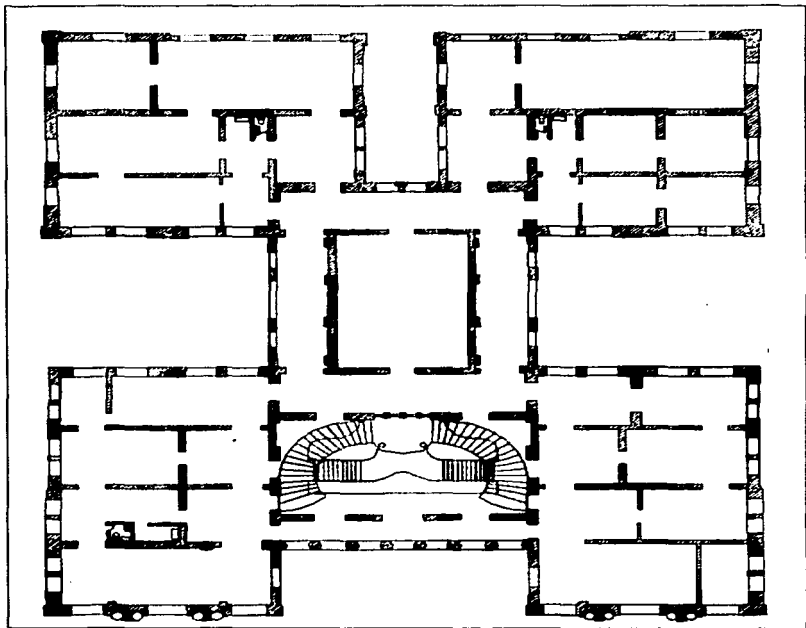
1.5(03) Planta alta del Instituto Nacional de Geología.
